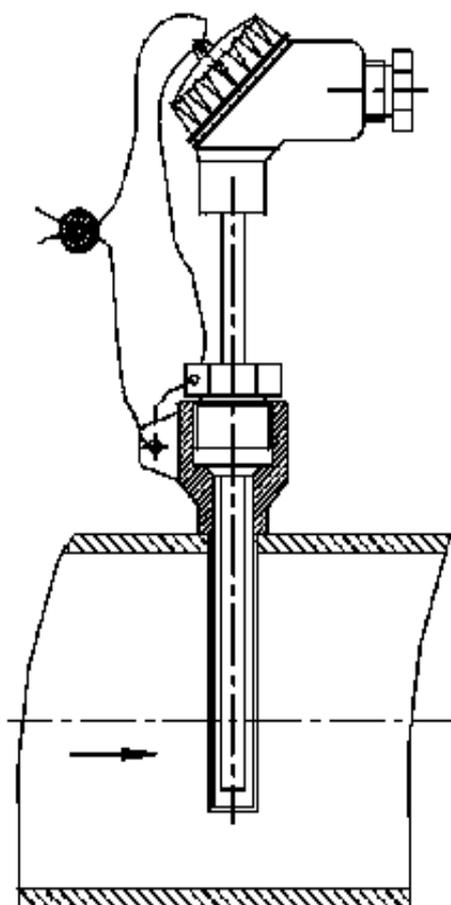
Схема монтажа термопреобразователя с защитной гильзой на трубопроводе (только для трубопроводов $D_u > 50$)
